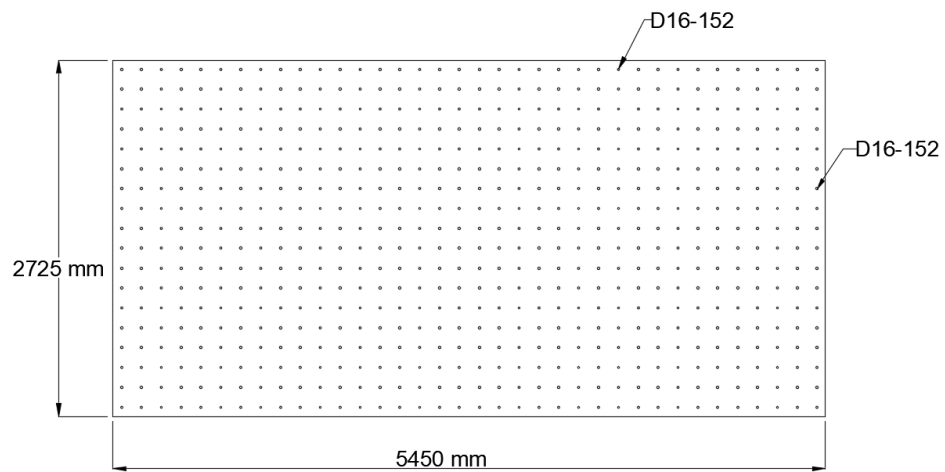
Detil penulangan sementara pada balok tipe-3 (trestel)
